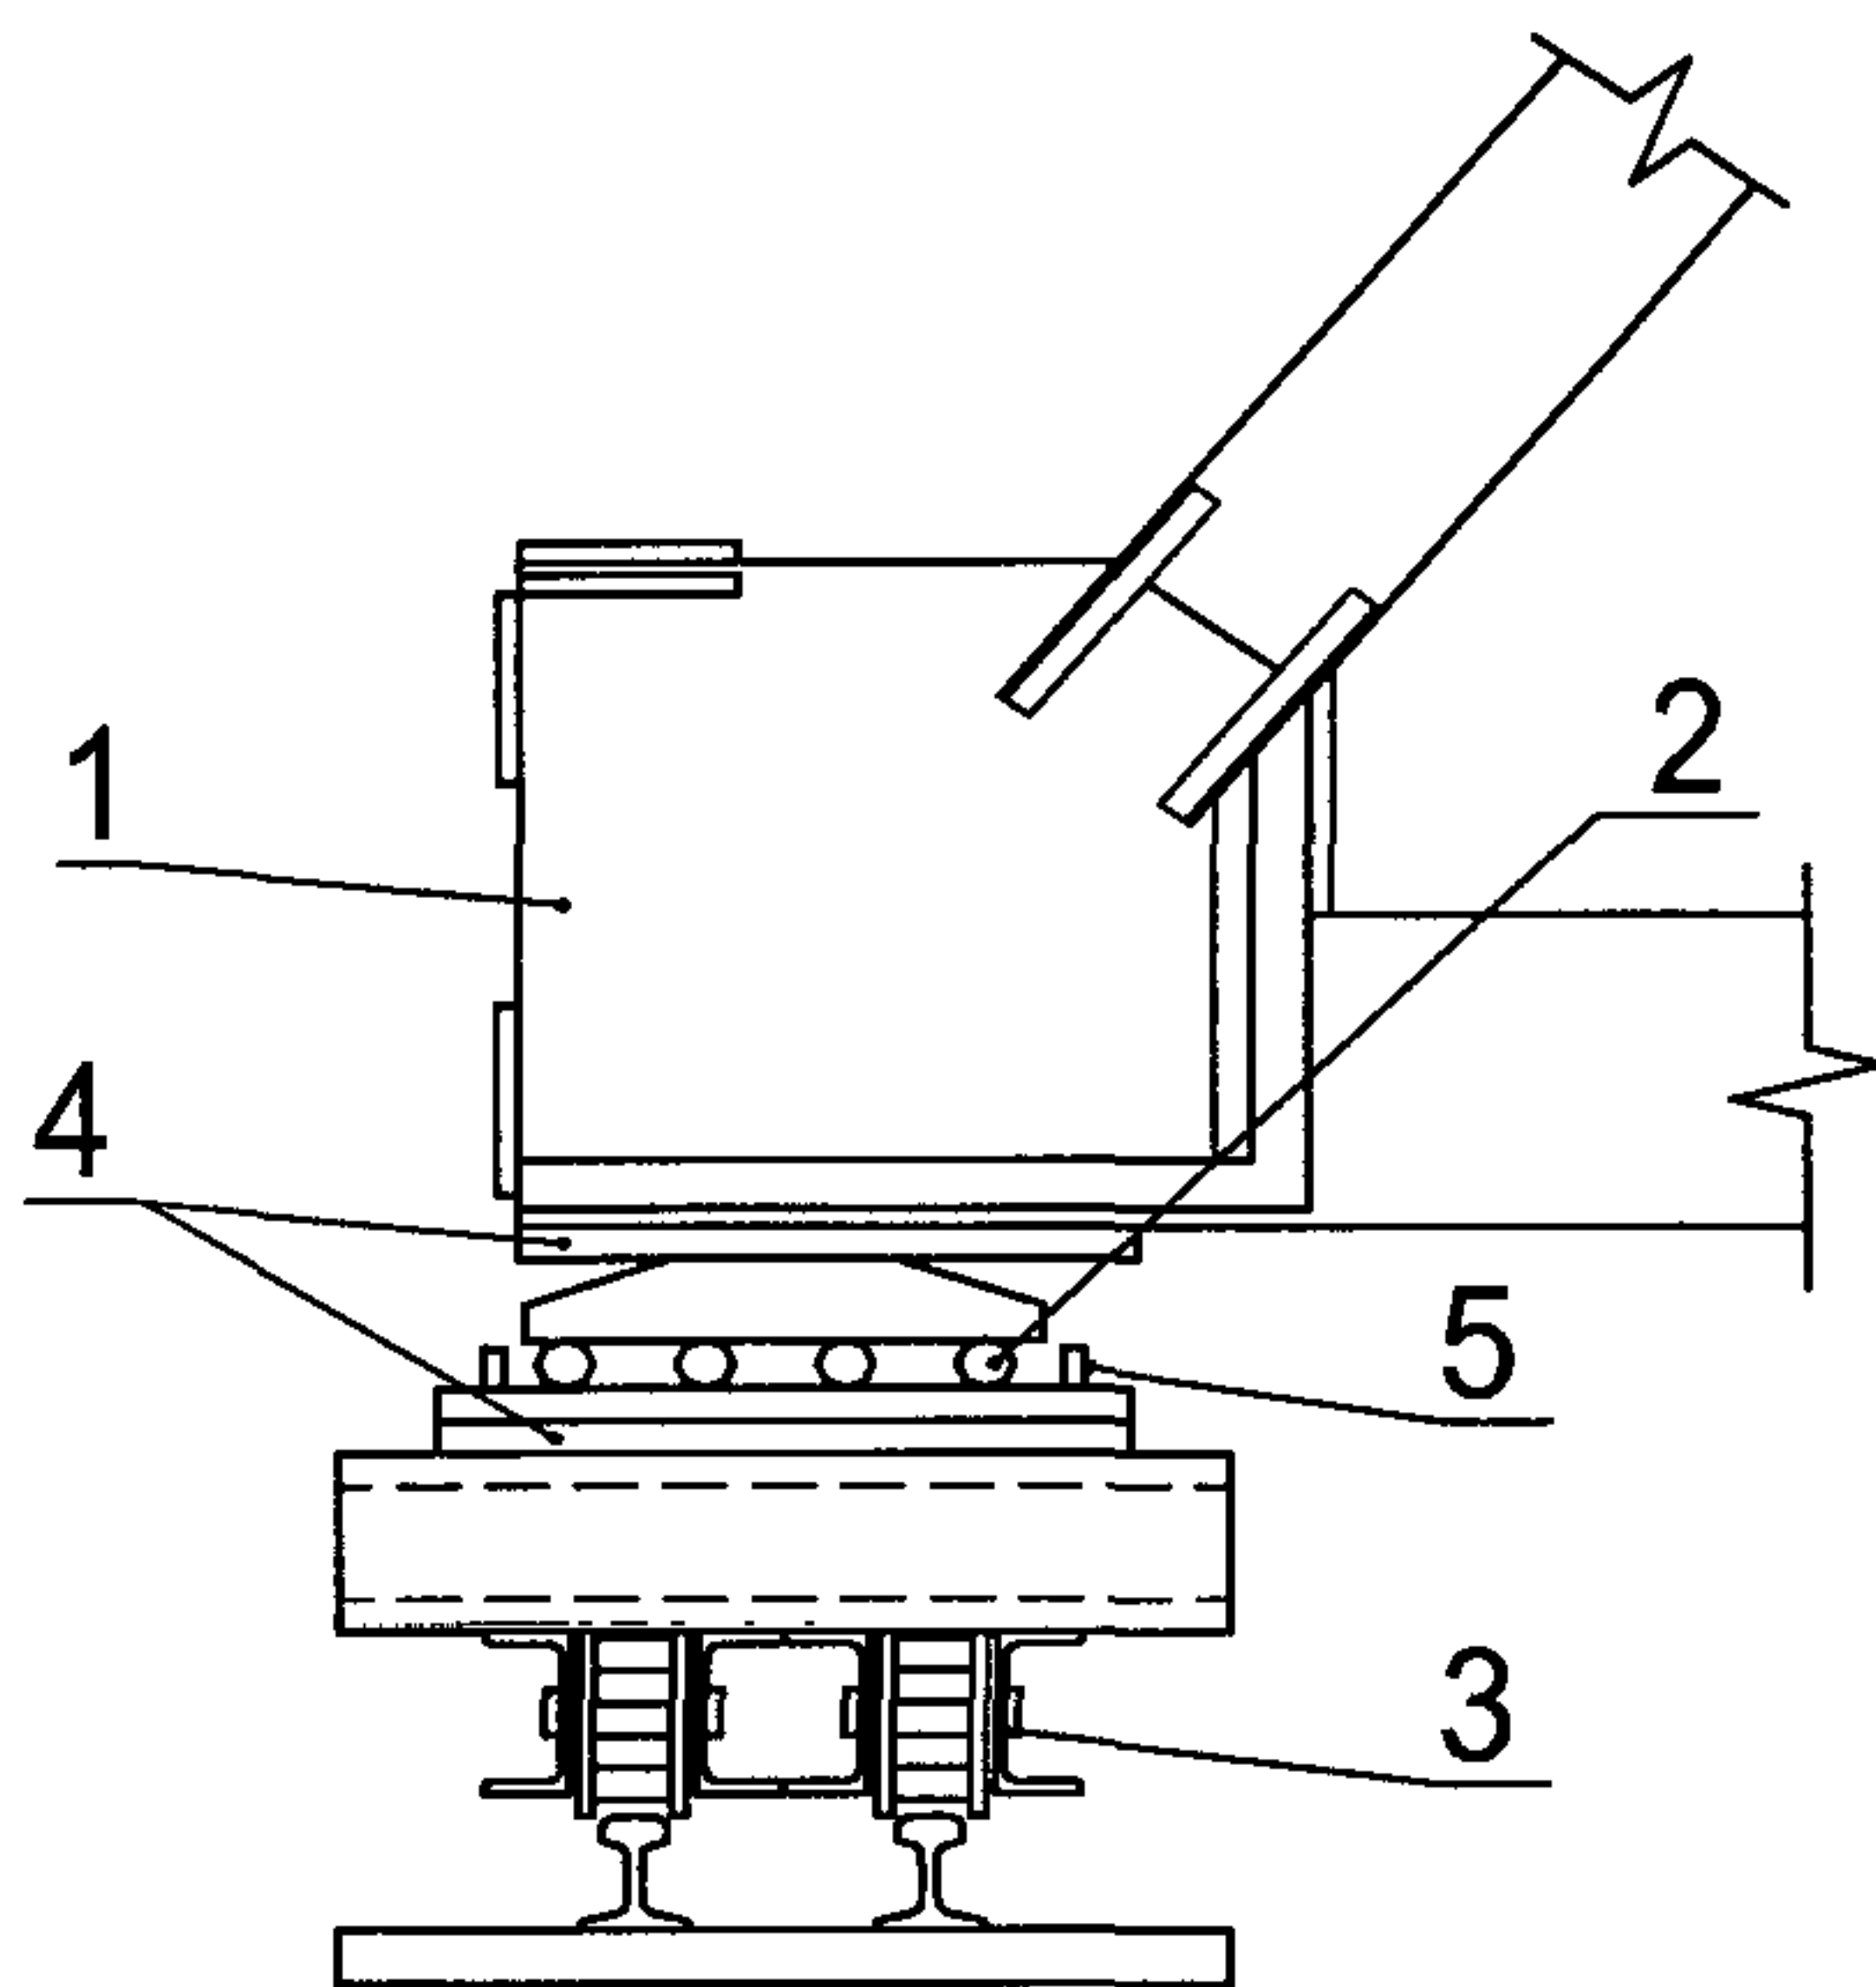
Опираие узла пролетного строения при поперечной перекатке на тележках
